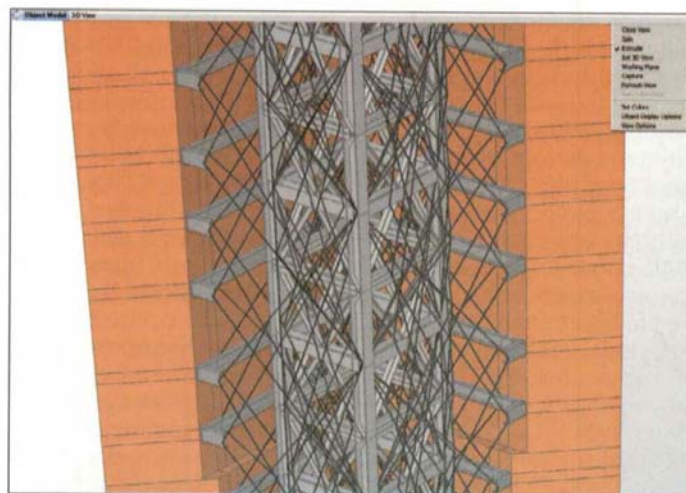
Il traliccio interno di consolidamento attivo della Torre San Dalmazio a Pavia
